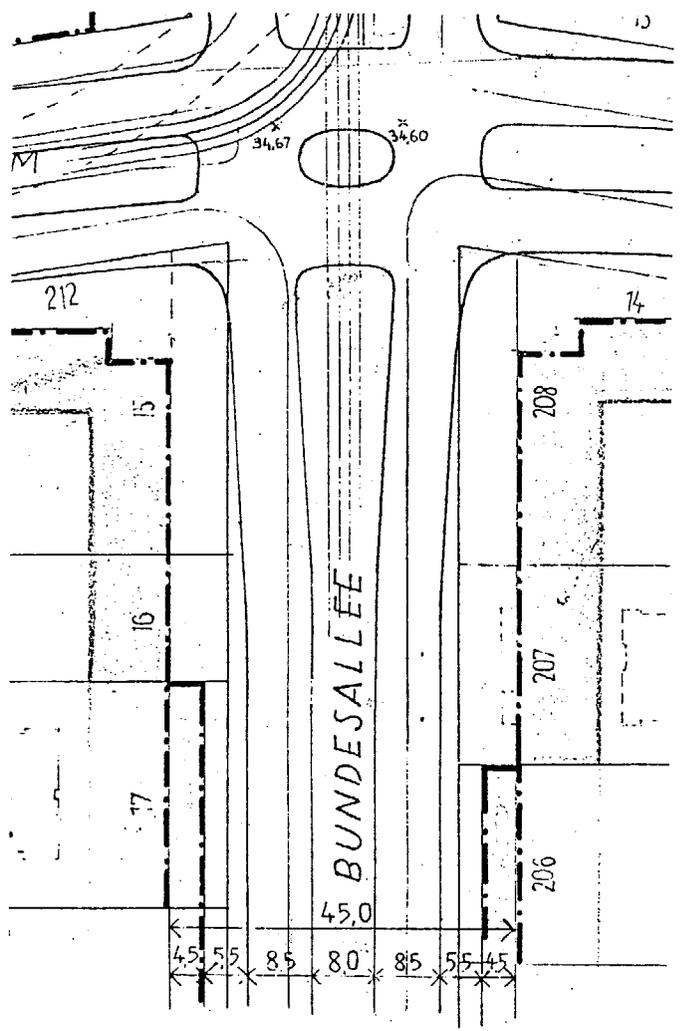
Geplanter Querschnitt der Bundesallee (Generalbebauungsplan 1953).
